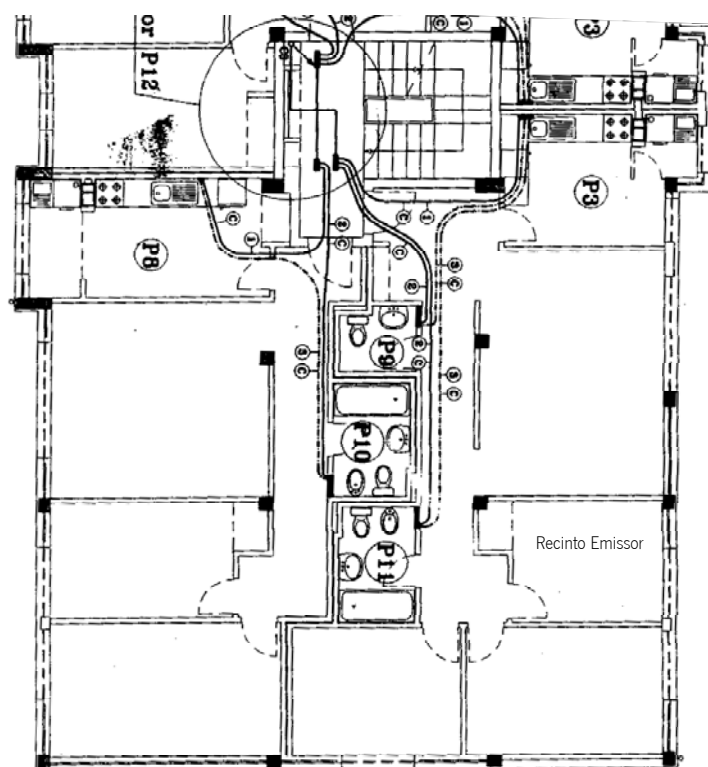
Planta do recinto receptor do ensaio de avaliação do isolamento da parede exterior 2, ParE2
